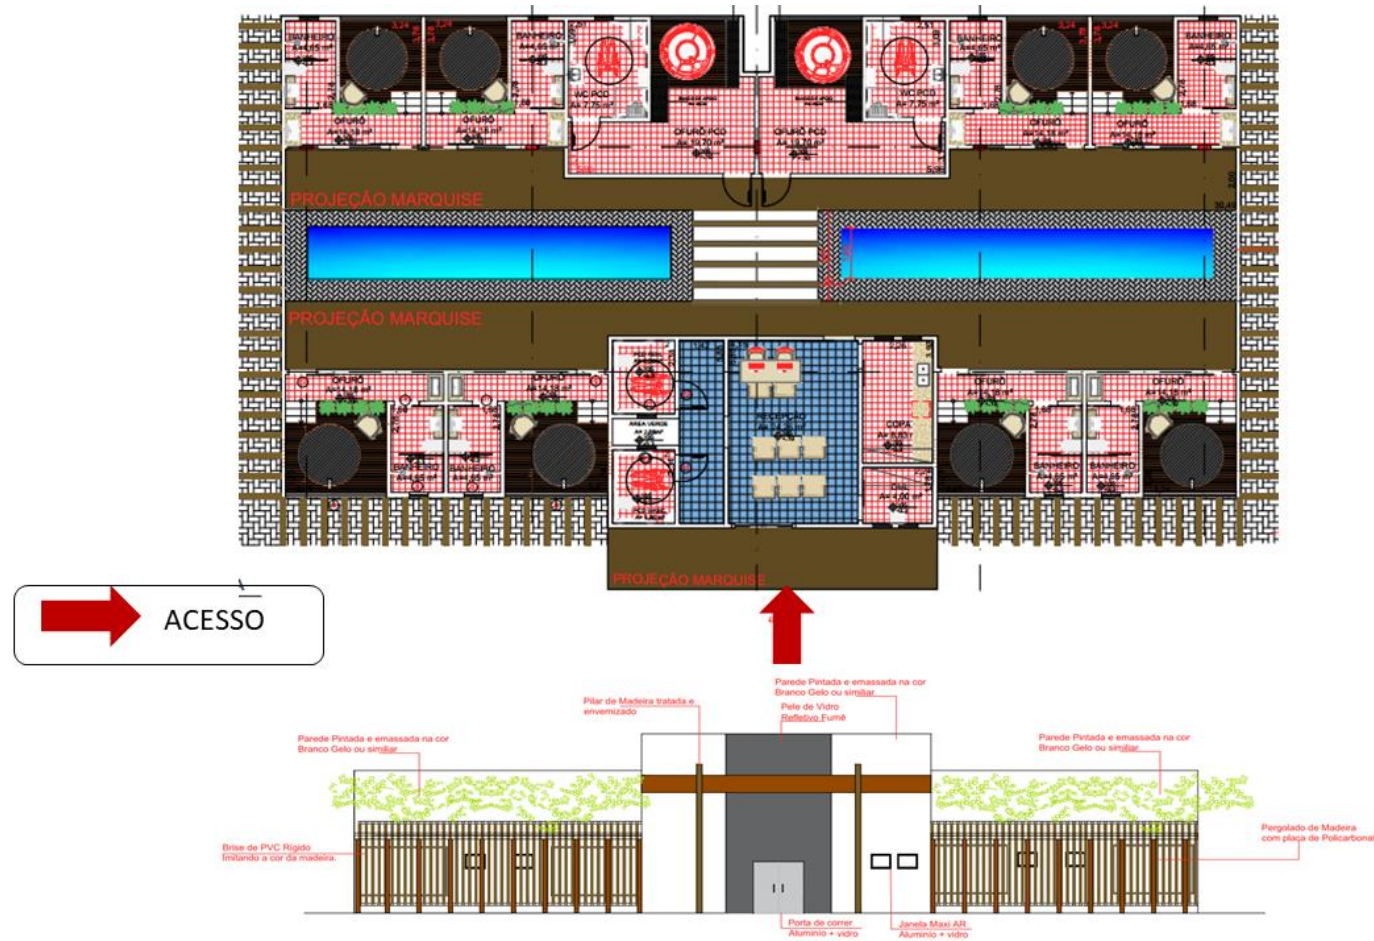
Bloco Restaurante: Planta Humanizada e Fachada
